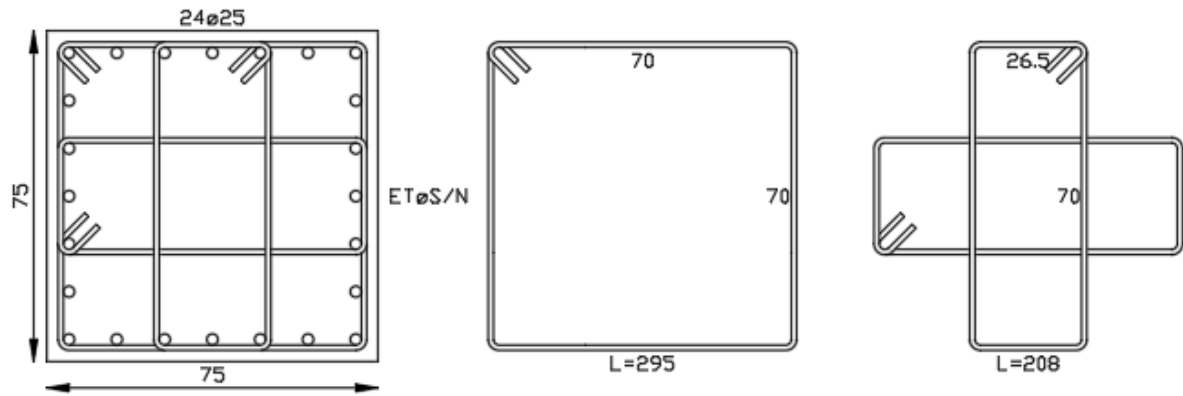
Columnas C01, Estructura de 20 pisos.
